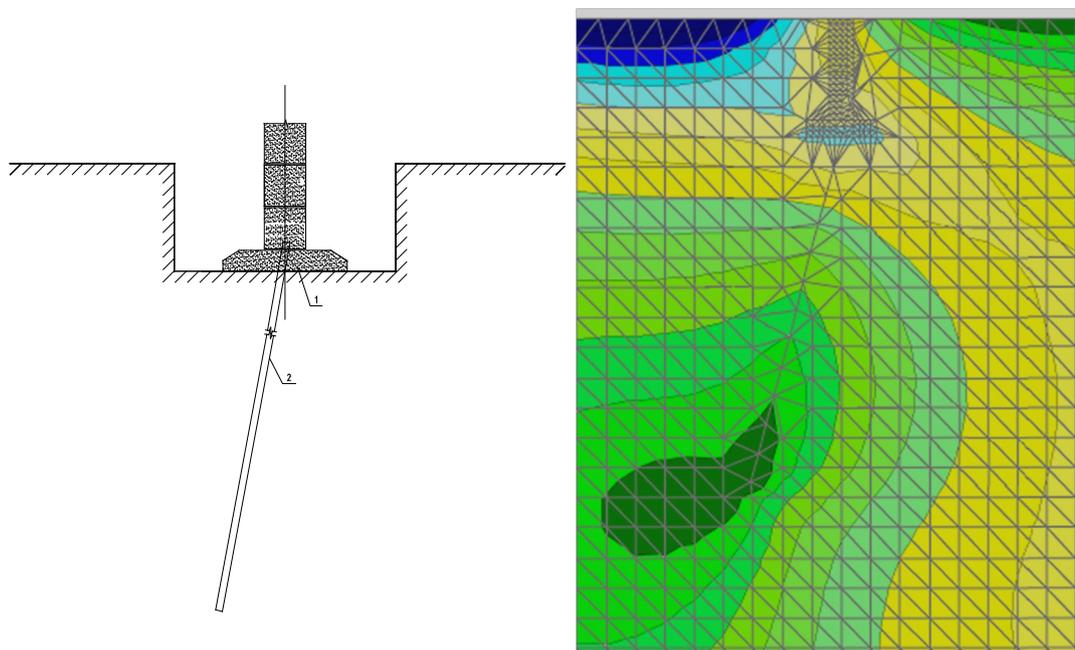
Схема усиления ленточного фундамента. 1-усиливаемый фундамент, 2- буронабивная свая
